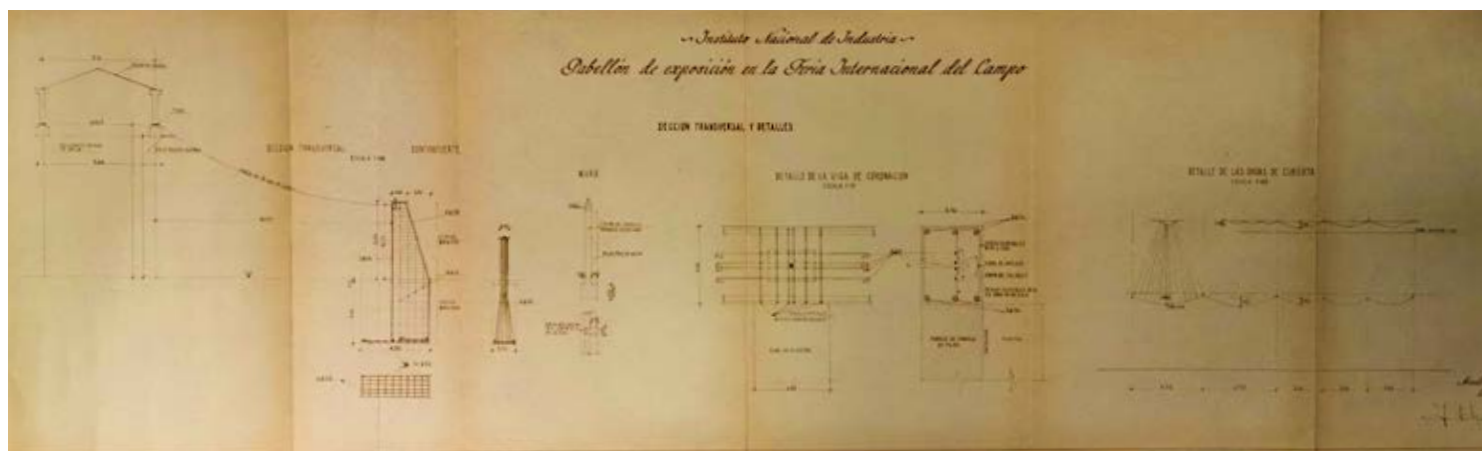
Sección transversal y detalles. INI, proyecto de pabellón de exposición en la Feria del Campo, 1953. Archivo SEPI.
